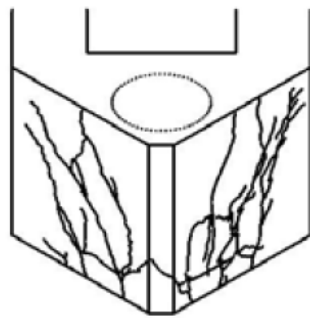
フーチング下面のひび割れ進行状況図 (CaseD, Pile B)
